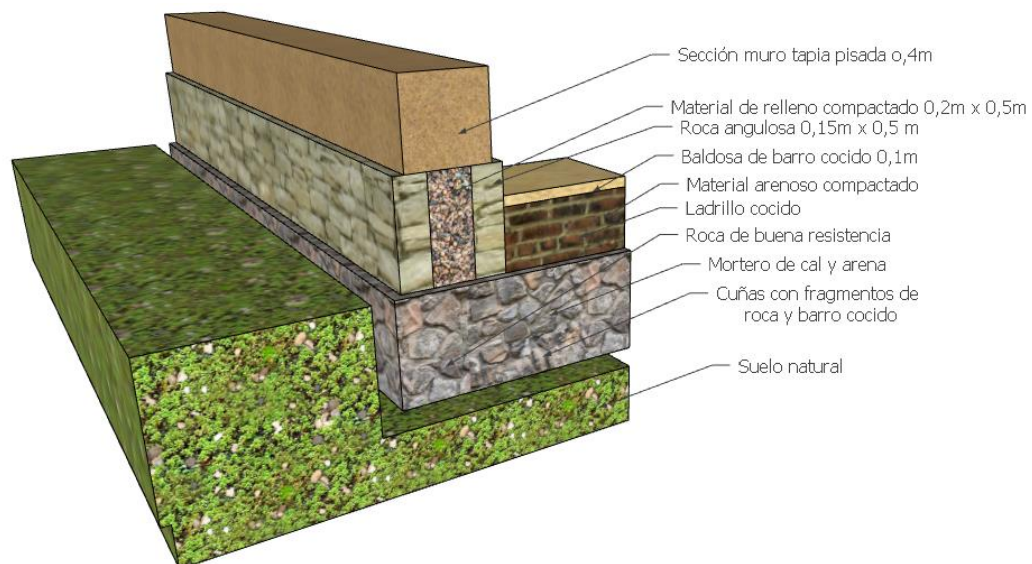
Corte arquitectónico de cimentación, Manual para viviendas en adobe y tapia pisada
